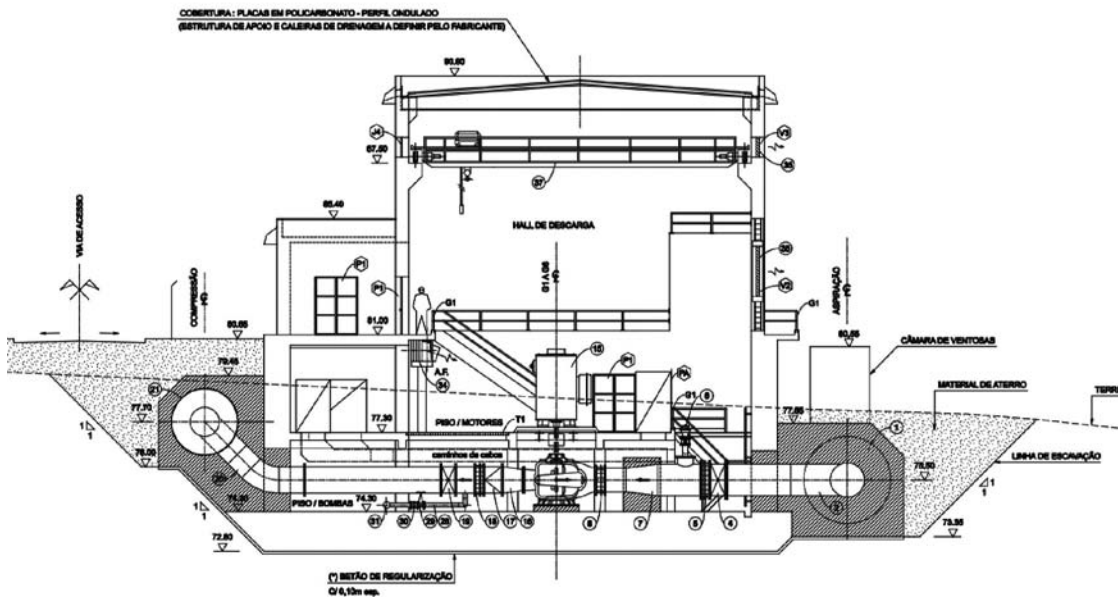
Estação Elevatória de Pedrógão M. Direita. Cortes Transversal
